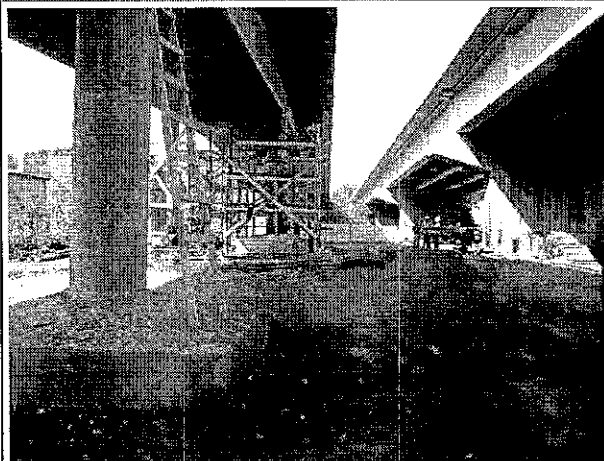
Área onde será instalado o canteiro de obras. Nota-se a construção dos pilares de sustentação da superestrutura que será removida. Os pilares antigos serão removidos com o uso de explosivos.
